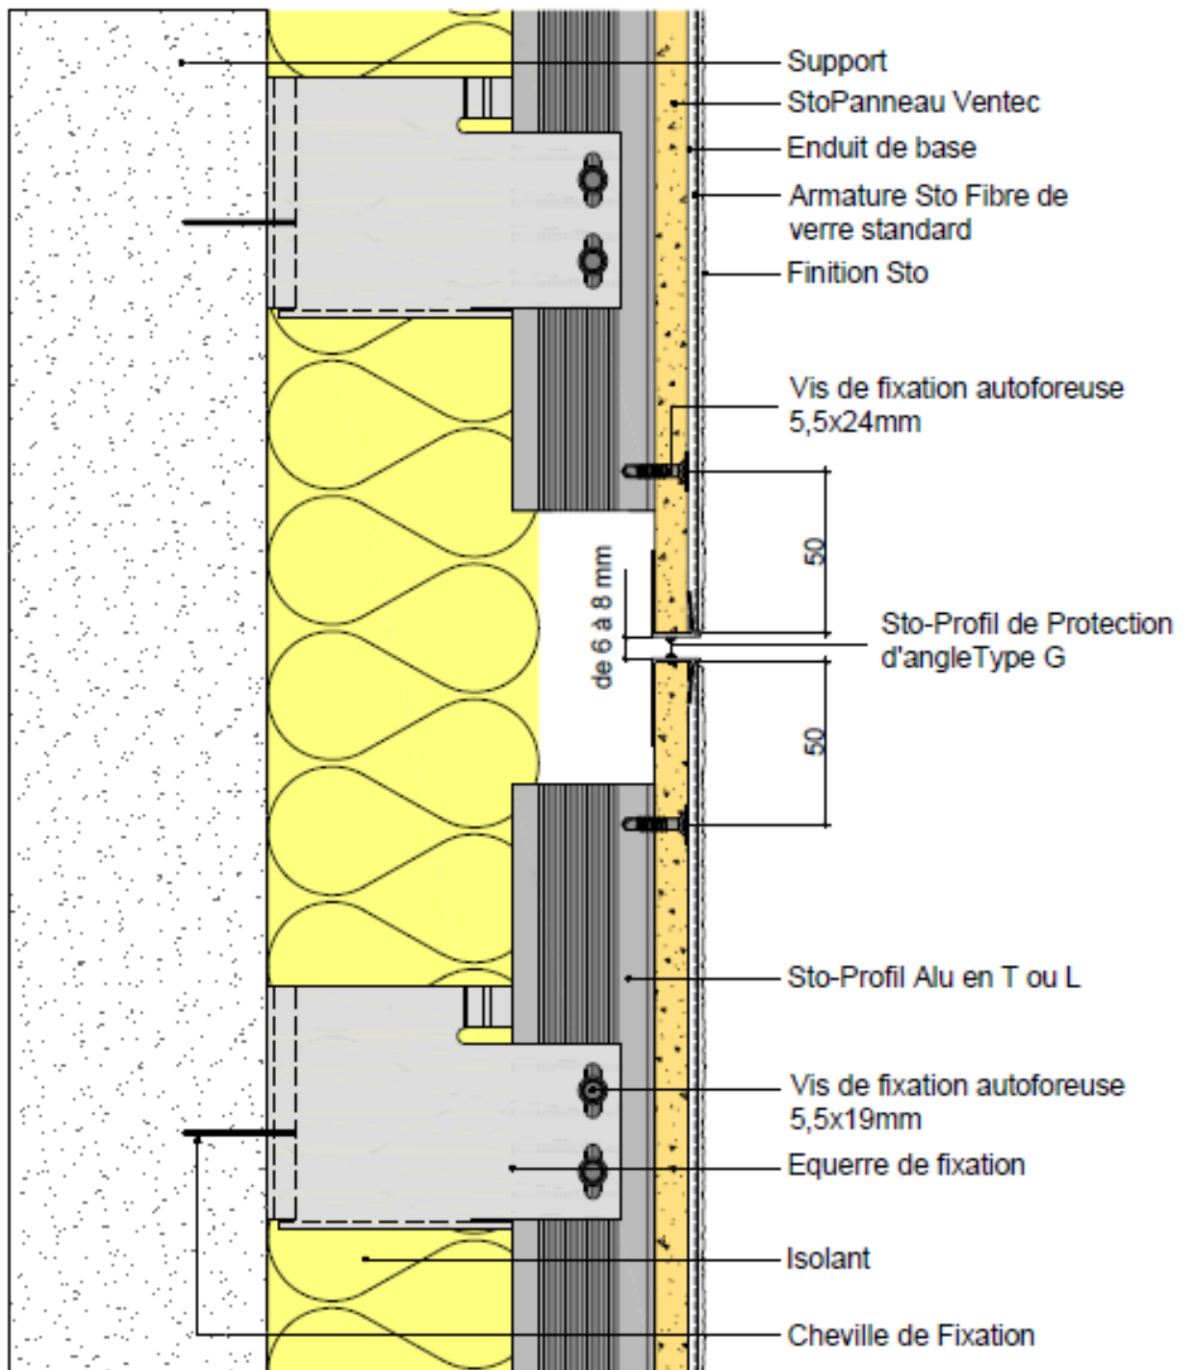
Coupe verticale - Fractionnement à joint ouvert - Ossature aluminium
